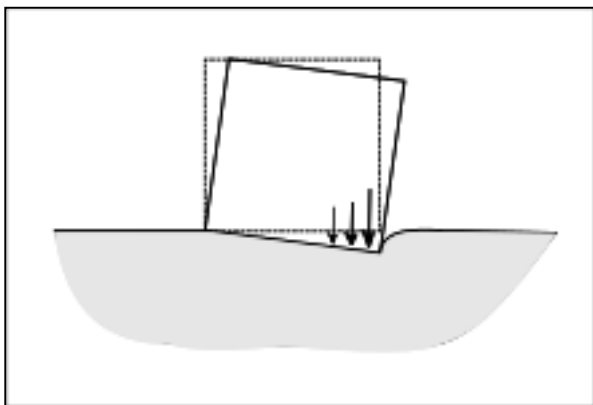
Représentation d'un tassement différentiel d'un bâtiment.
